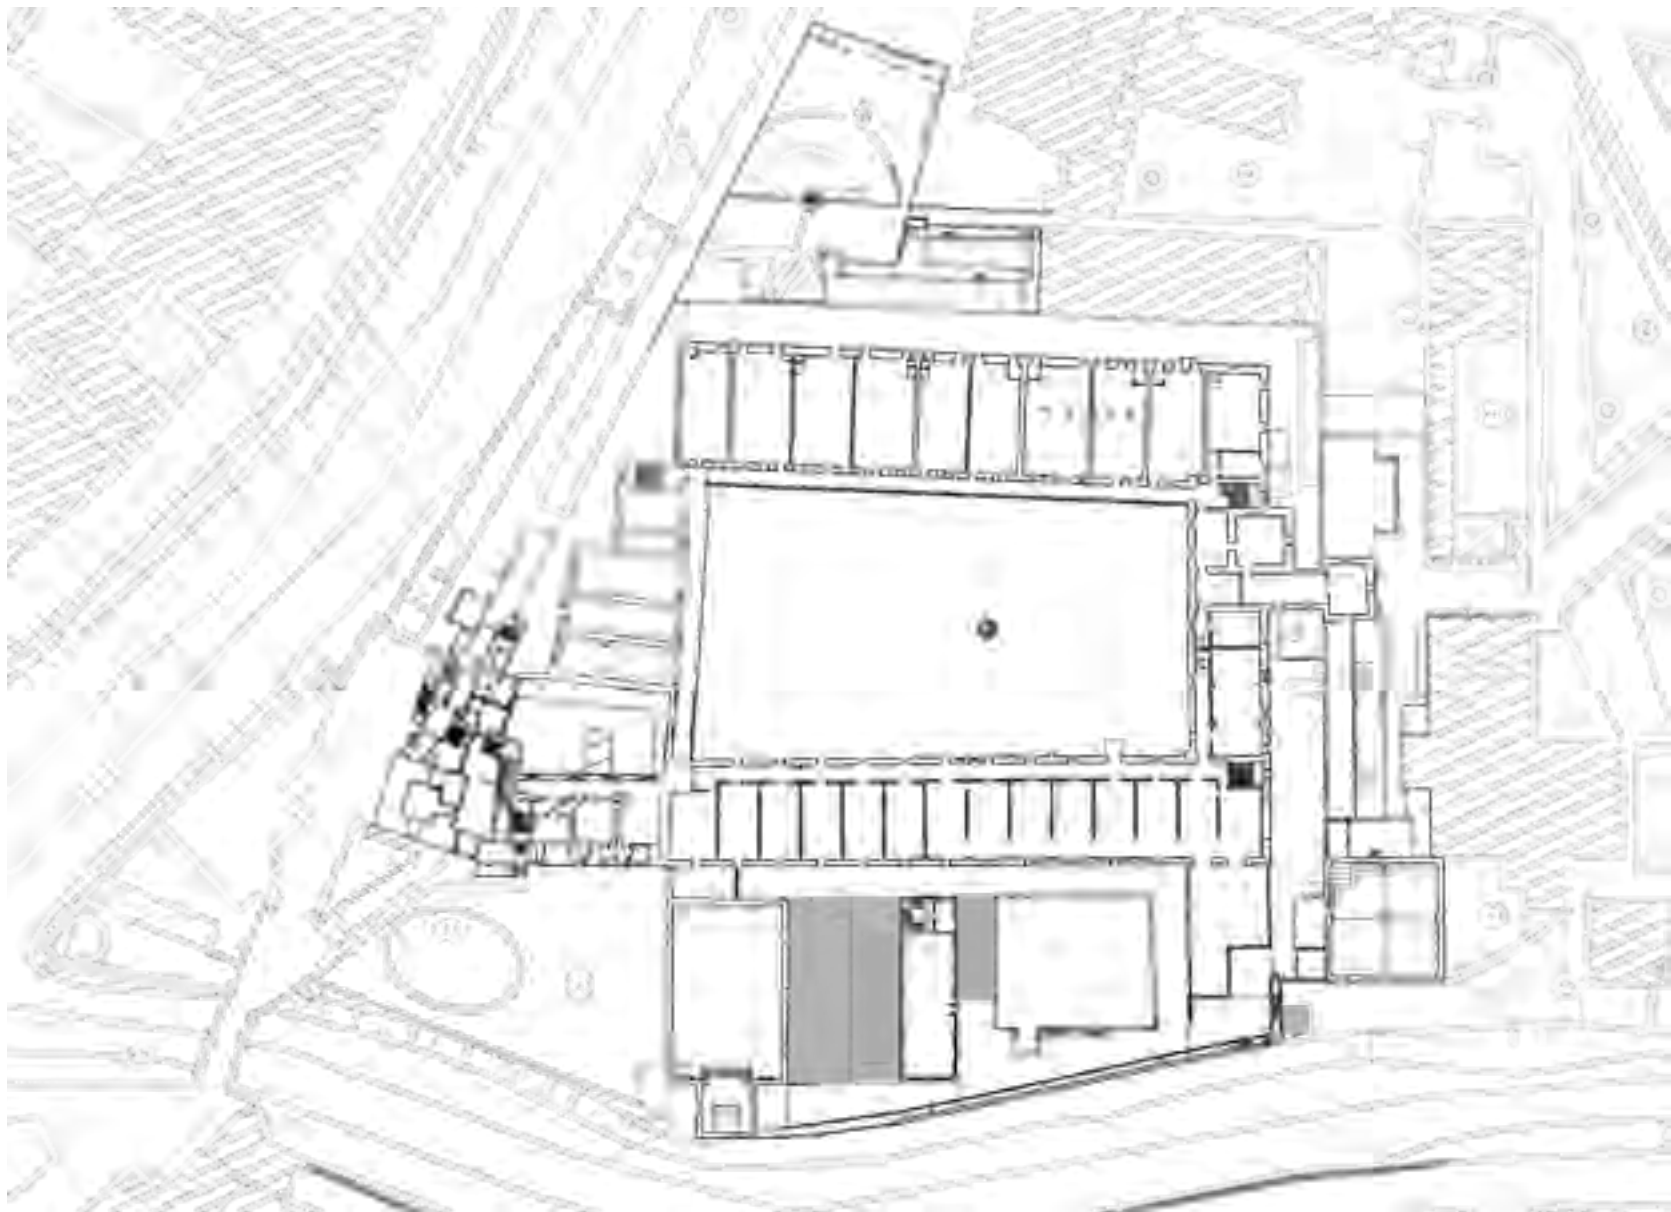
Planimetria attuale del castello carrarese, piano primo.
